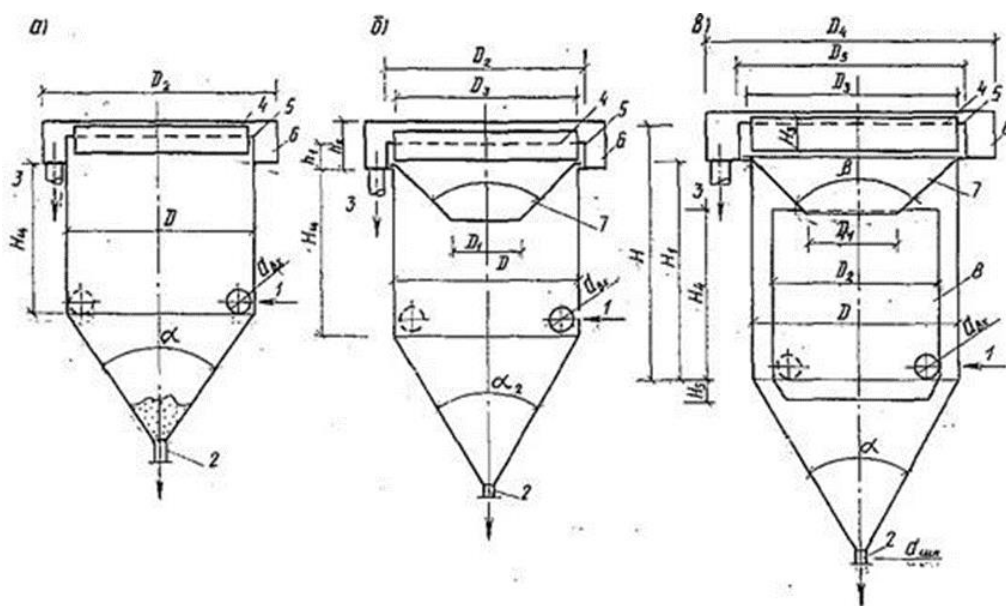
Открытые гидроциклоны: а — без внутренних устройств; б — с конической диафрагмой; в — с конической диафрагмой и цилиндрической
